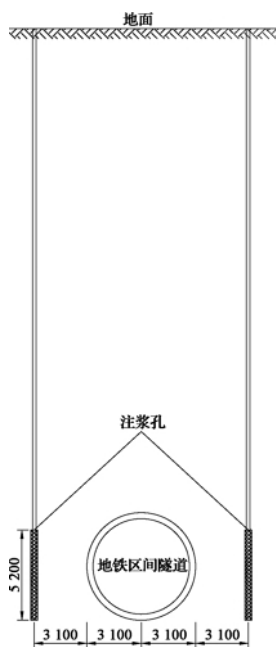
地铁区间隧道微扰动注浆孔布置剖面示意图(单位:mm)
